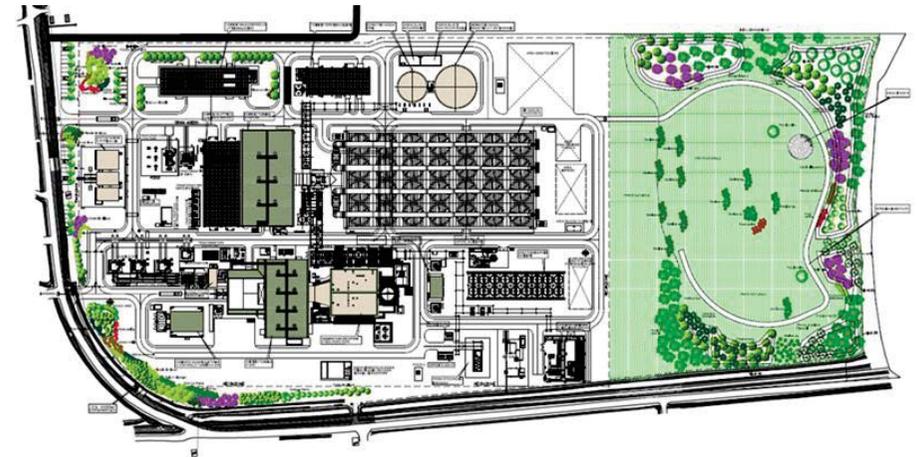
Planimetria della Centrale prevista nel Progetto Esecutivo
